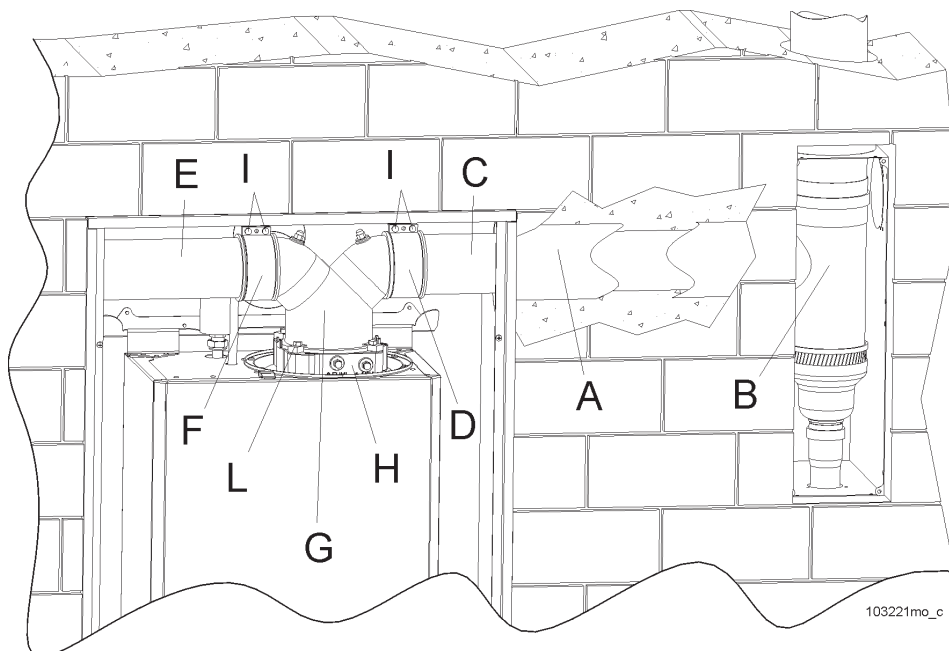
Installazione del sistema "sdoppiato 80/80"
